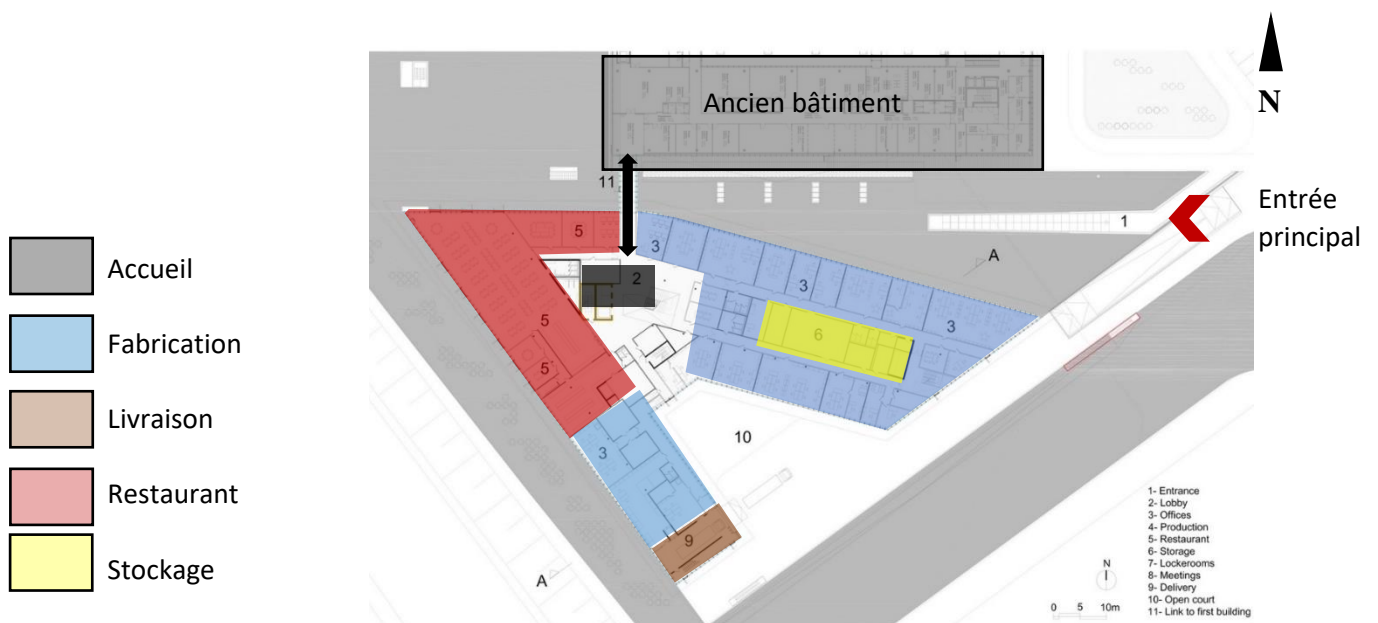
plan du RDC de l'extension traité par auteur - Source : ArchDaily
